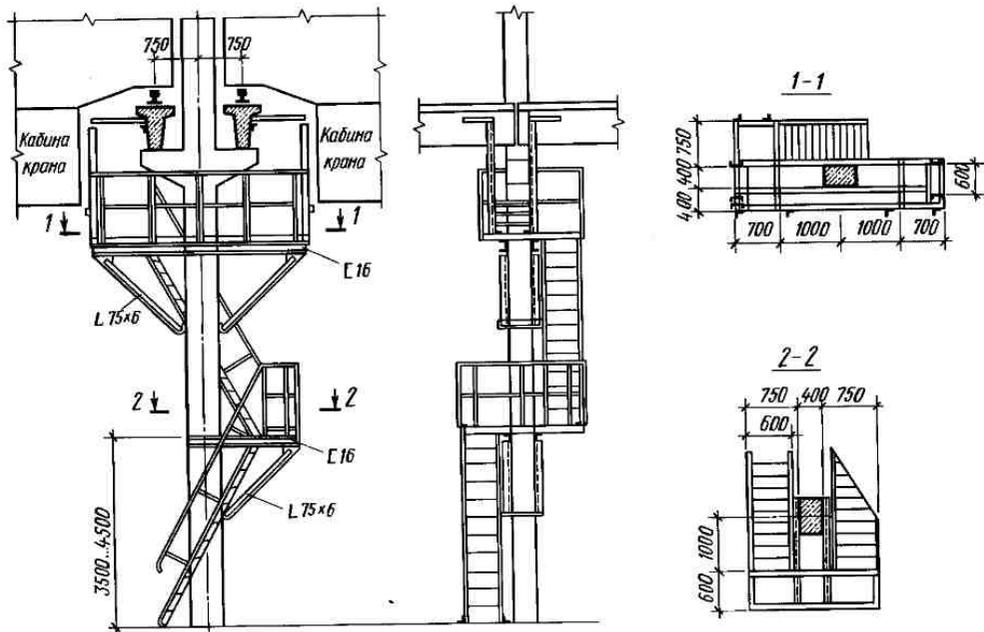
Устройство служебной лестницы и посадочной площадки для мостового крана у внутренней колонны цеха
